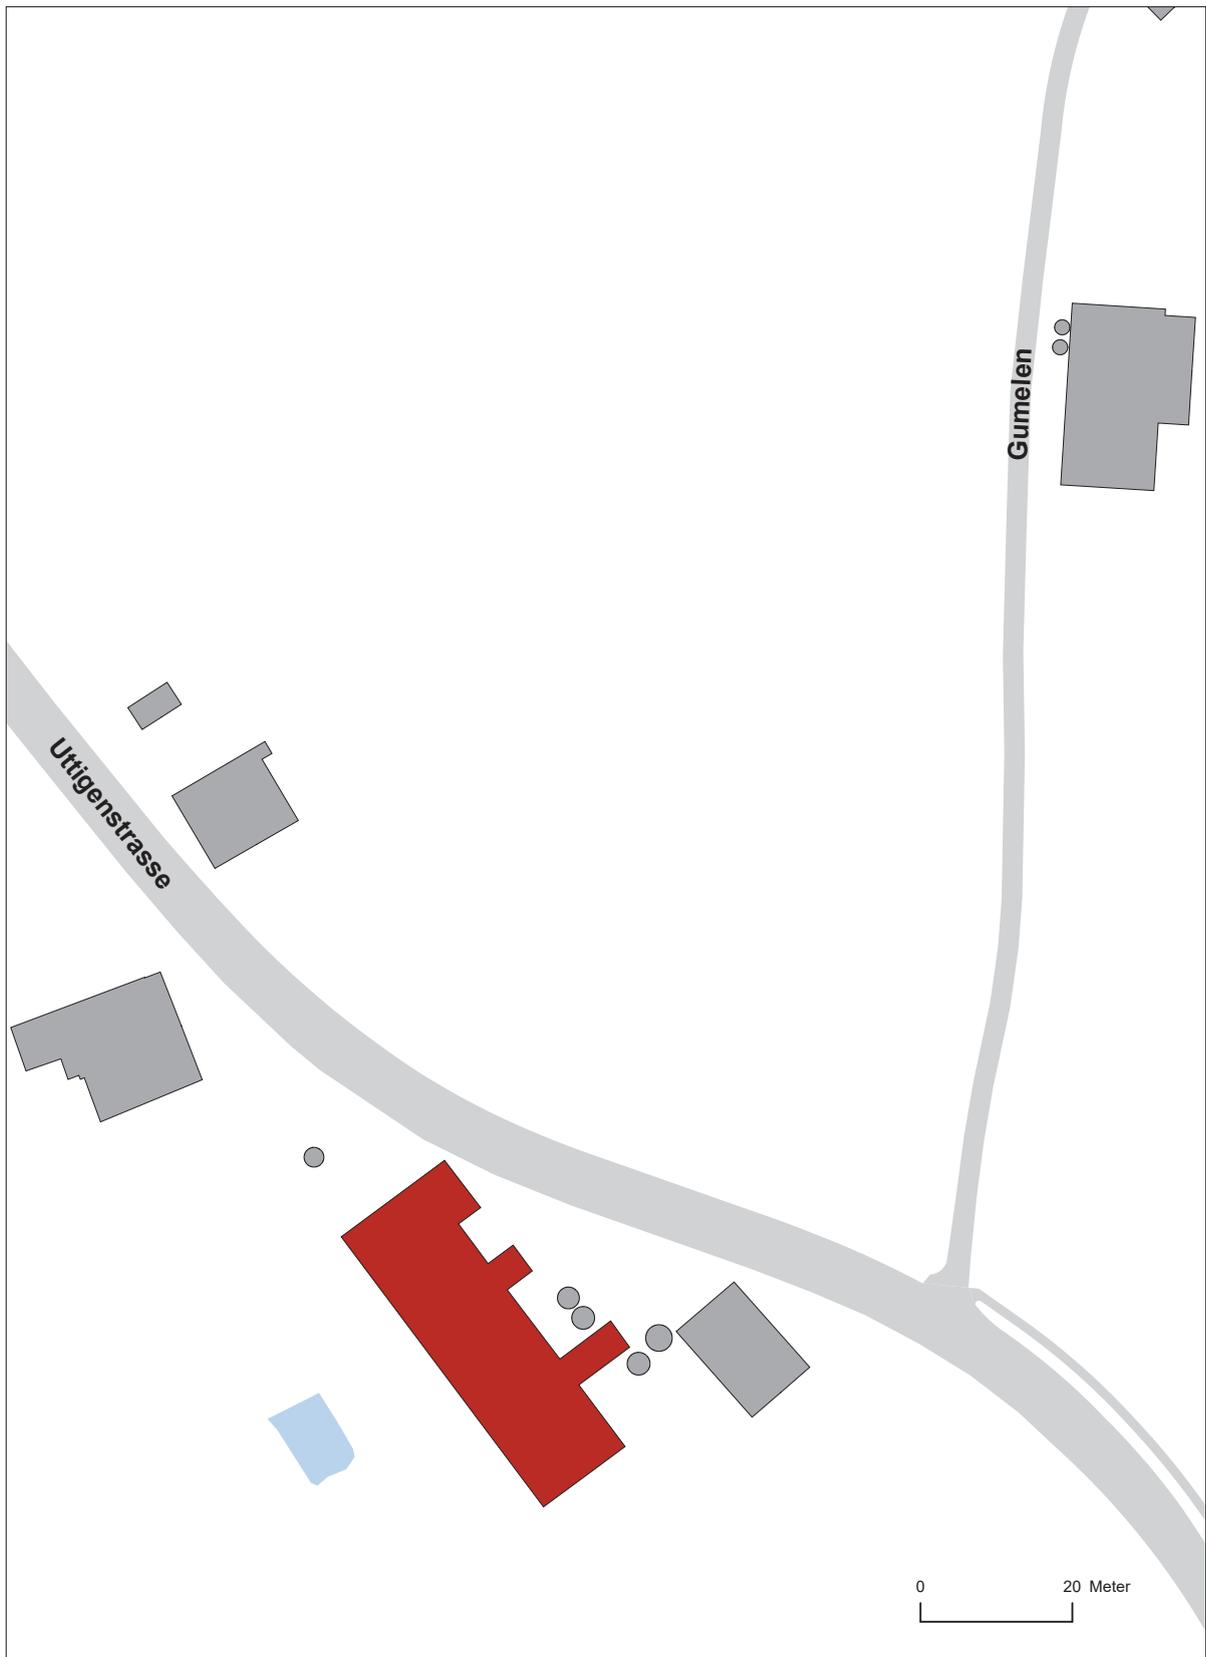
Kirchdorf, Situationsplan 1:1'000. Rotes Objekt: Uttigenstrasse 2a
